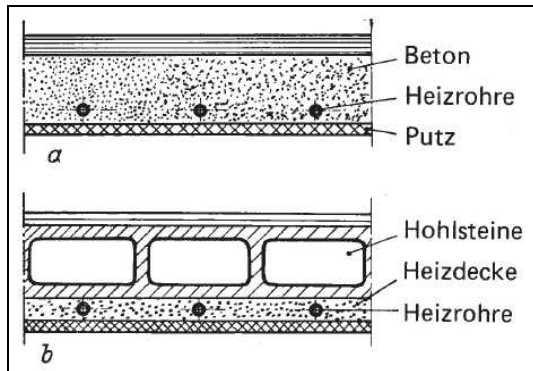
Rohr-Deckenheizungen mit Heizrohren in Beton.
